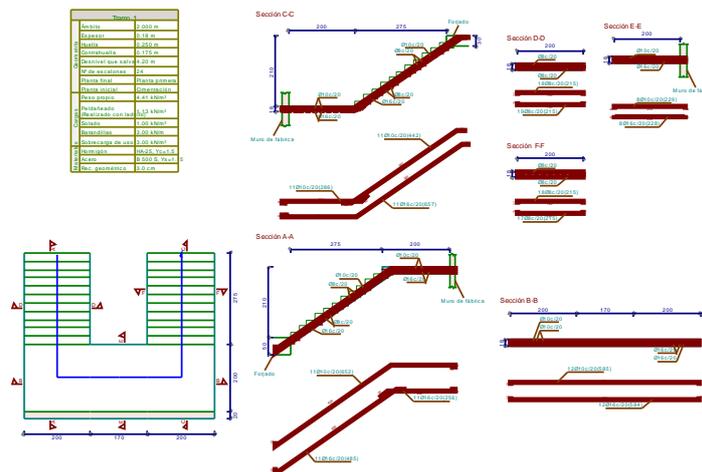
Escaleras (Fuente: CypeCad).
